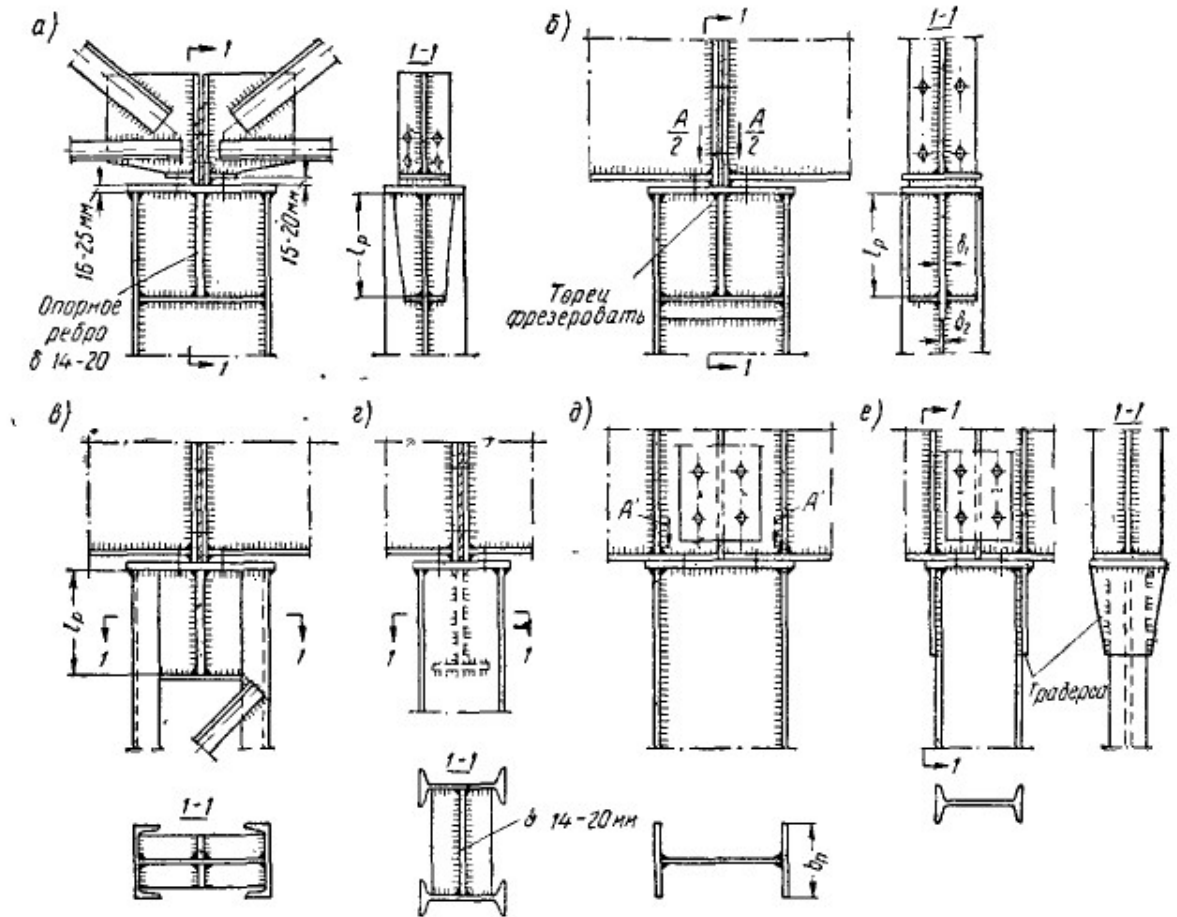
Оголовки колонн при опирании конструкций сверху.
